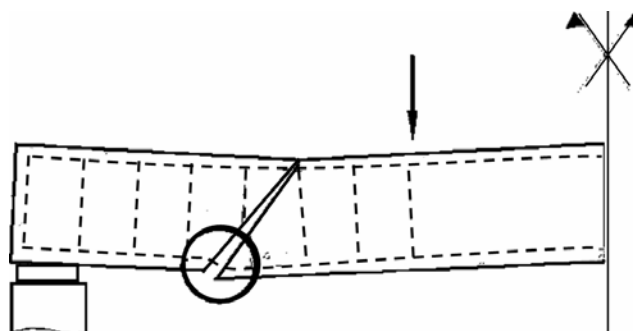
Ruína por flexão localizada da armadura longitudinal
